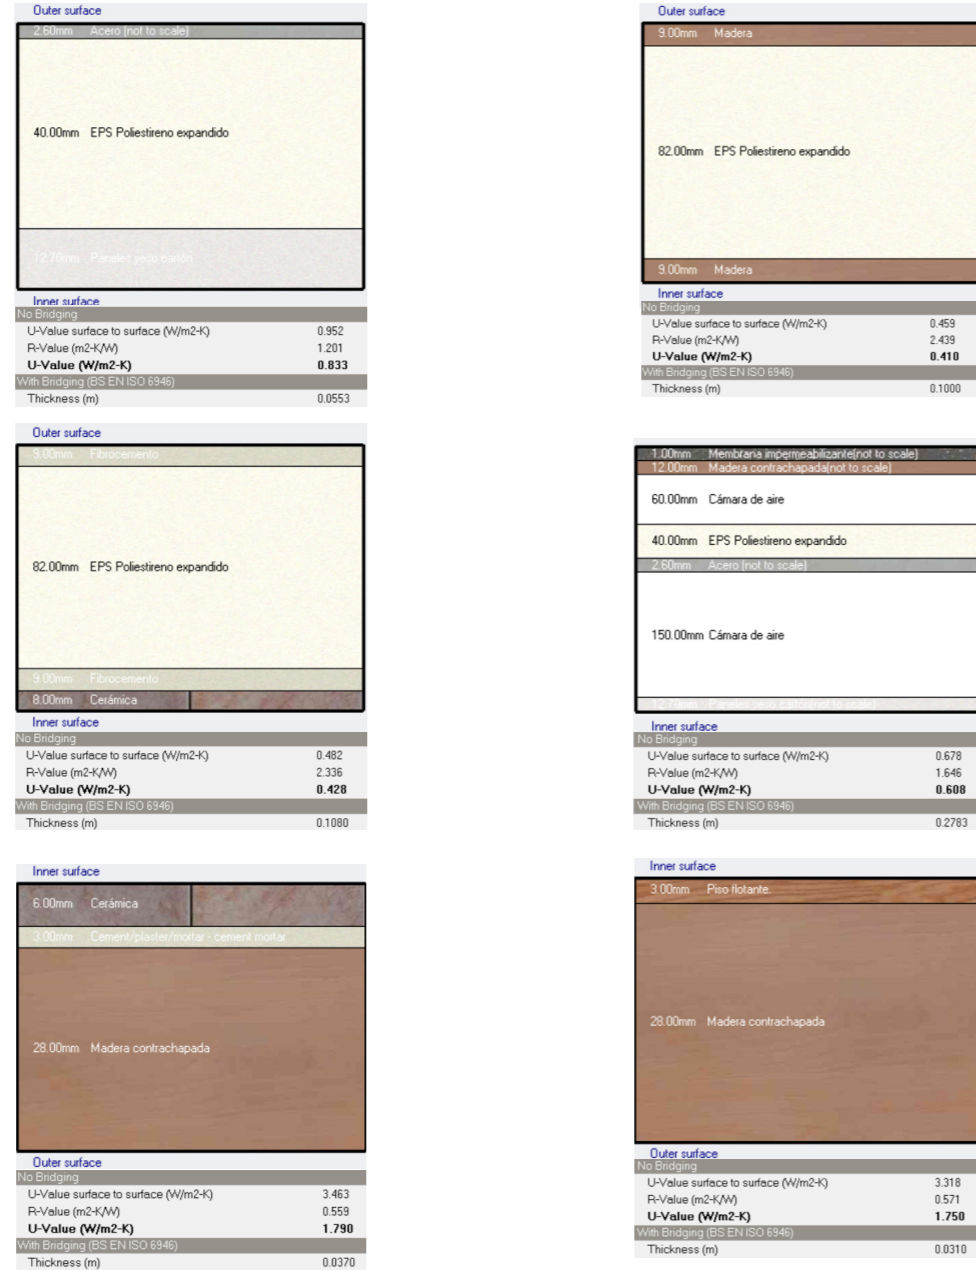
Paquetes constructivos de la vivienda (Design Builder) Fuente: Autores, 2023
